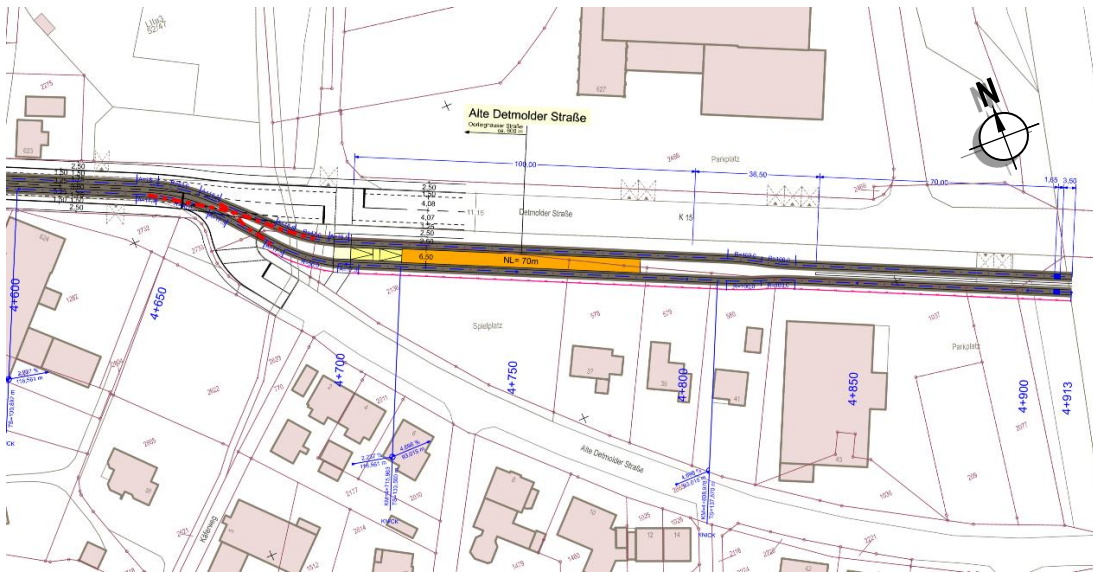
Lageplan Endpunkt – Lange Variante
